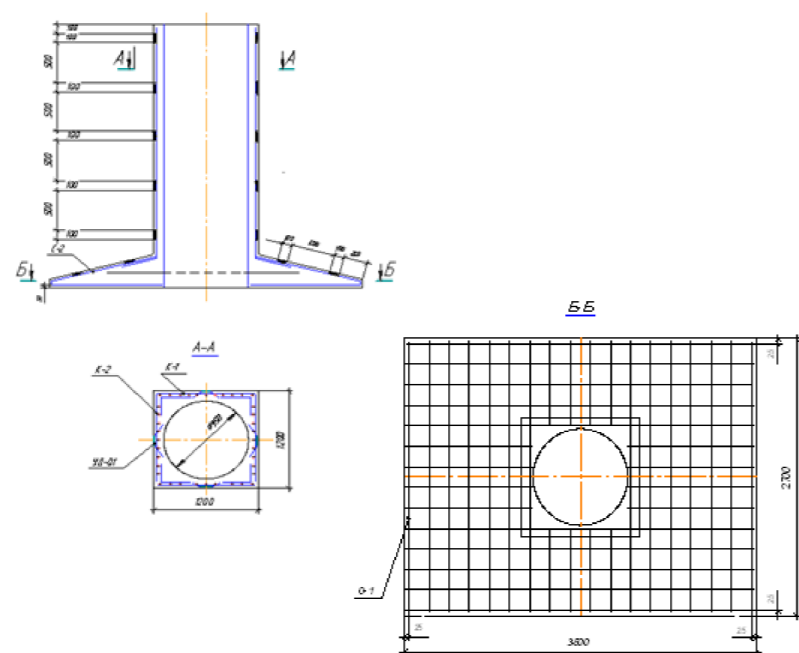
Мембранный фундамент с полкой стойкой прямоугольной формы
